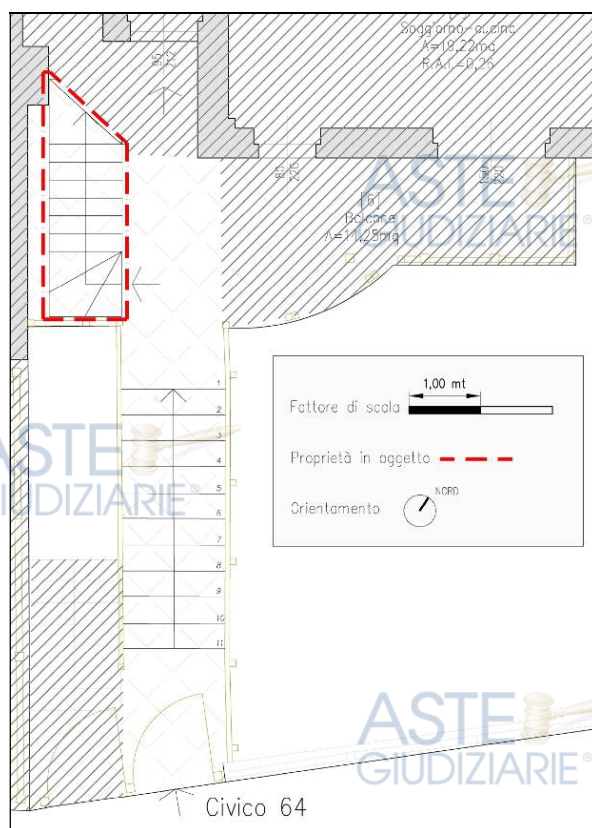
Piano terra – Pianta di rilievo scala esclusiva - Part. 336 sub. 53
